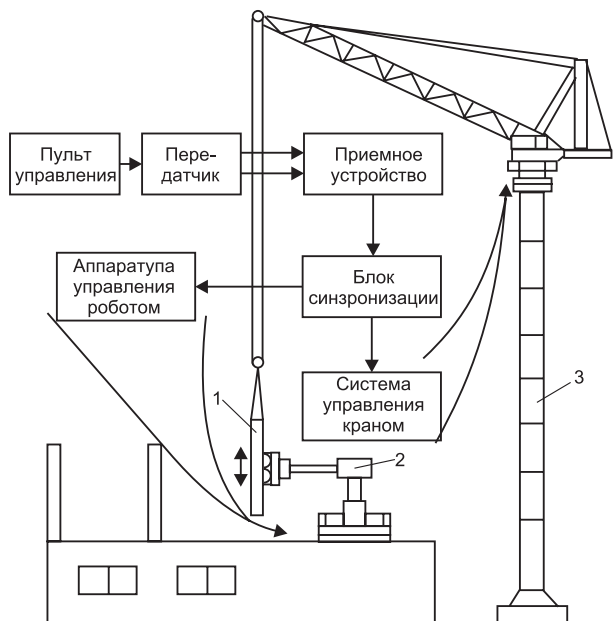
Установка железобетонных колонн с помощью робота
